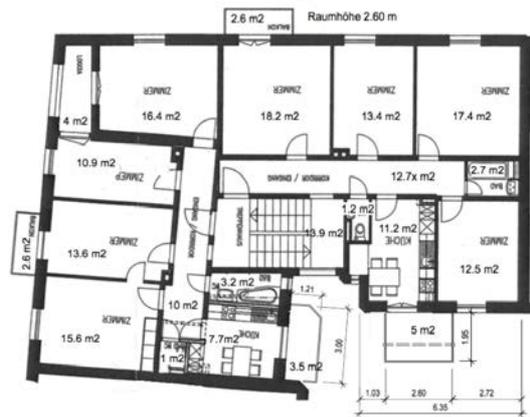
Grundriss OG, Gertrudstrasse 54, 4-Zimmer-Wohnungen
